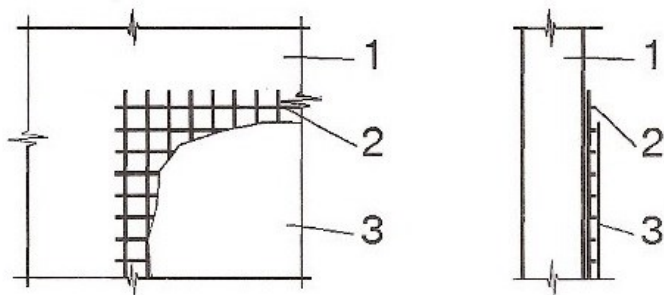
Схема посилення залізобетонної стіни армованим полімербетоном:
